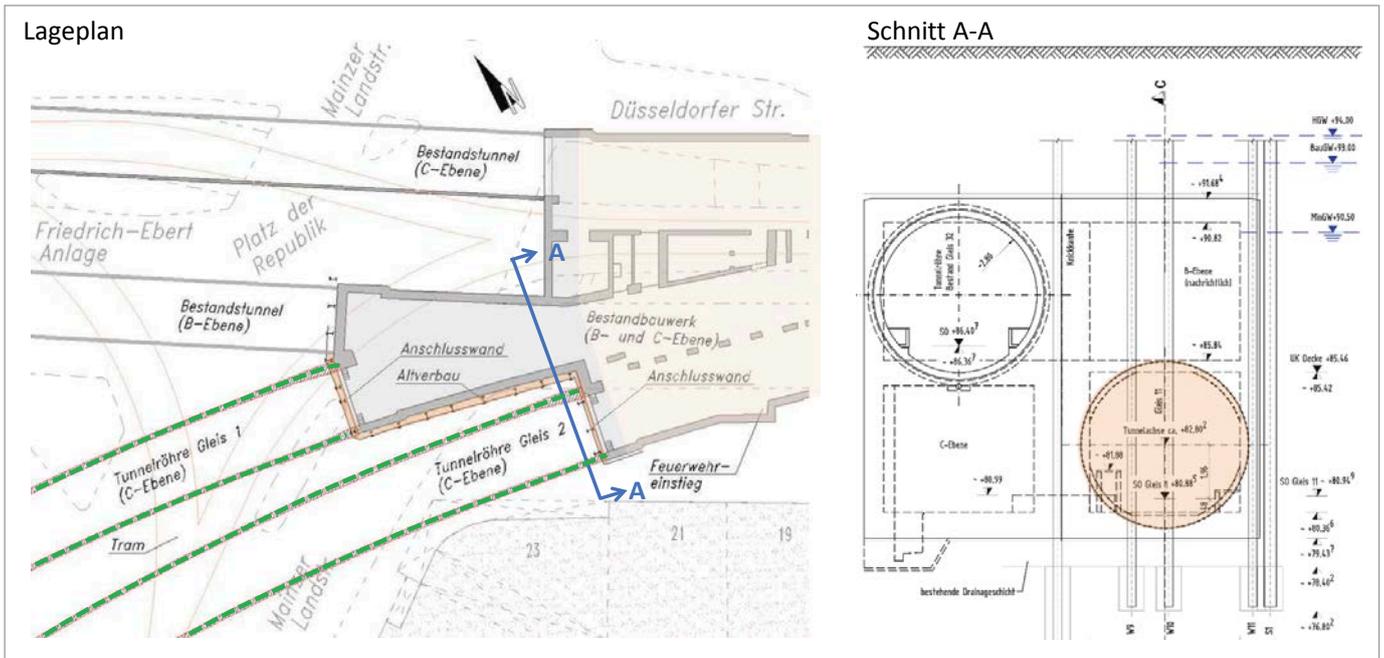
Bestandssituation im Anschlussbereich Platz der Republik und neue Tunnelröhre (grün)
